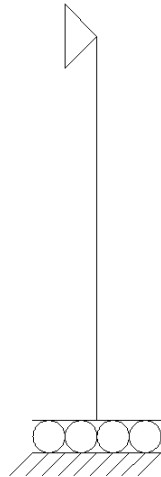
Funcionamento estrutural simplificado da parede de contenção para o fim da escavação
